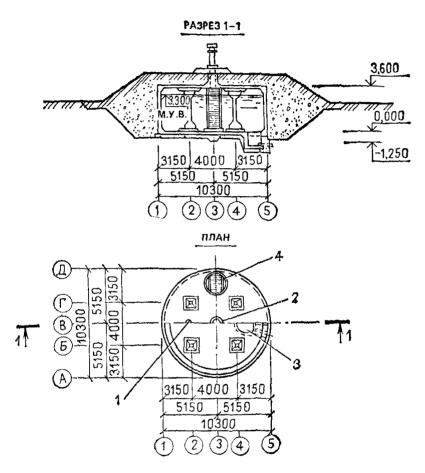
Резервуар для воды вместимостью 250 м³ цилиндрический из монолитного железобетона для строительства в районах сейсмичностью 8 и 9 баллов. Типовой проект 901-4-50с (к ценам № 358, 359)
